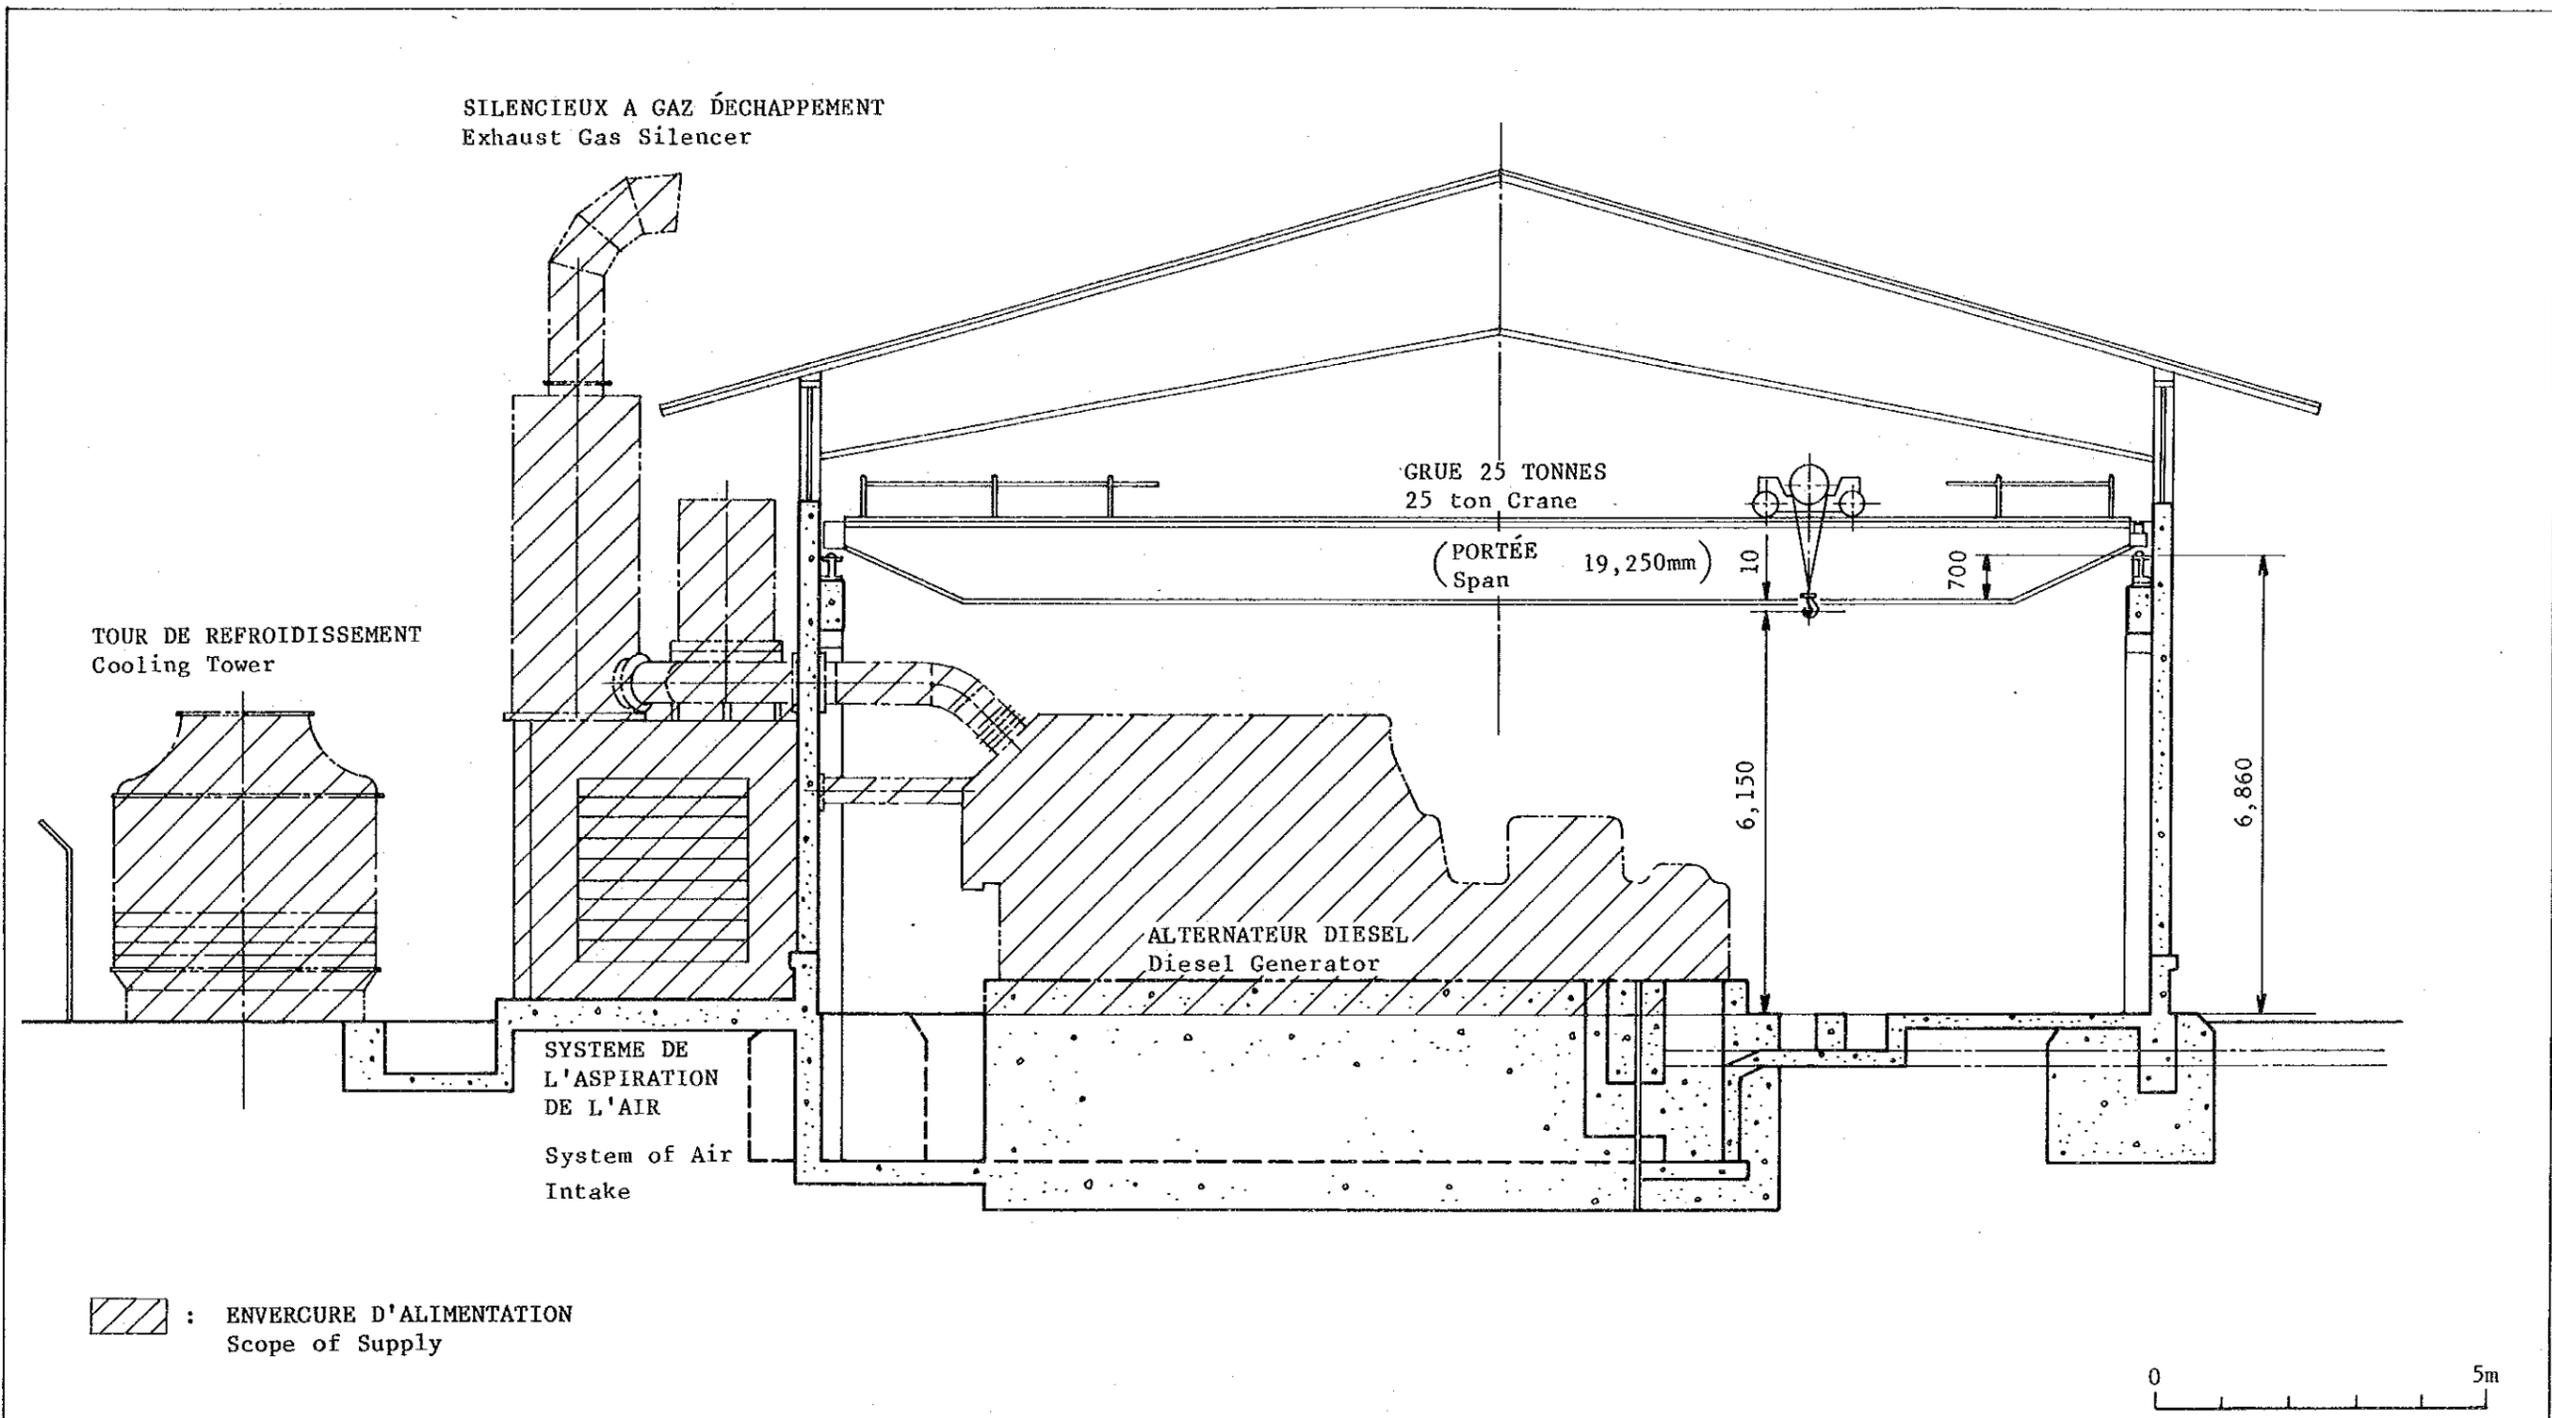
2 CENTRALE DE TOMBO DESSIN SECTIONNEL DU BÂTIMENT
